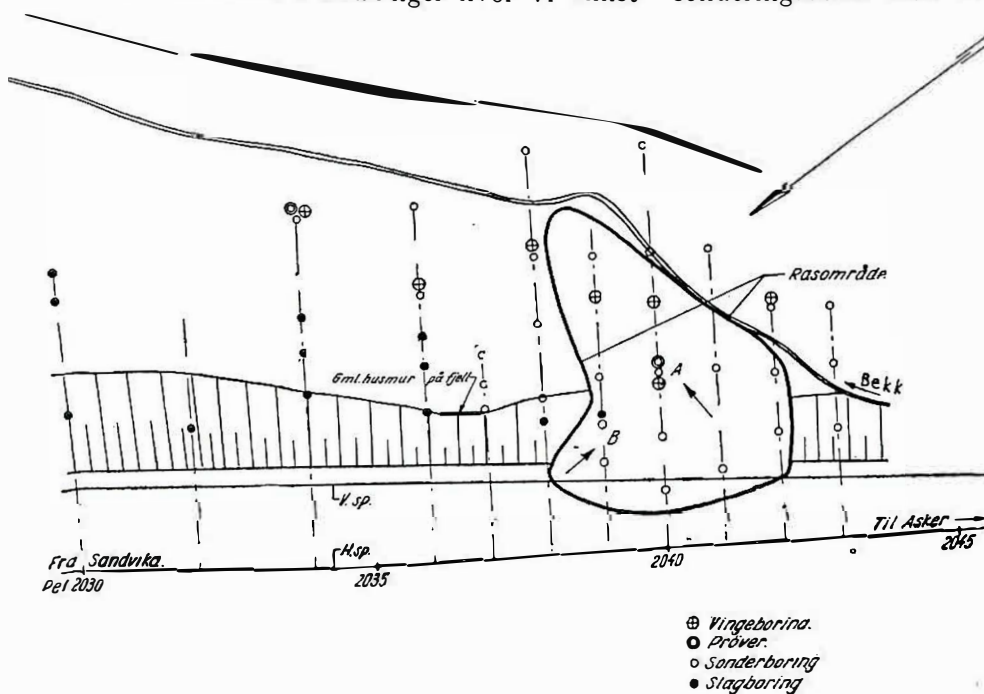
Vakås 1954. Drammenbanens dobbeltsporanlegg. Ut-rasning av 9 m høy fylling. Planeringen var på det nærmeste ferdig, da underliggende leirgrunn sviktet. Pil A betegner hovedretning for ras, pil B etterras.
